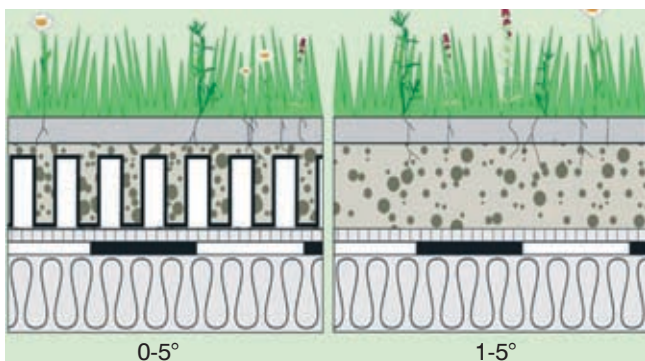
Układ konstrukcyjny dachu ekonomicznego w zależności od nachylenia [7]
